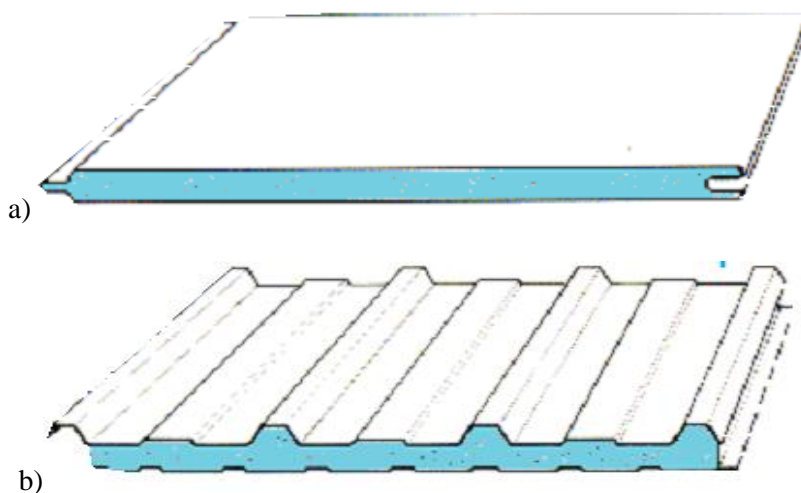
Exemplos de perfis de painéis sandwich: a) liso, b) trapezoidal.
